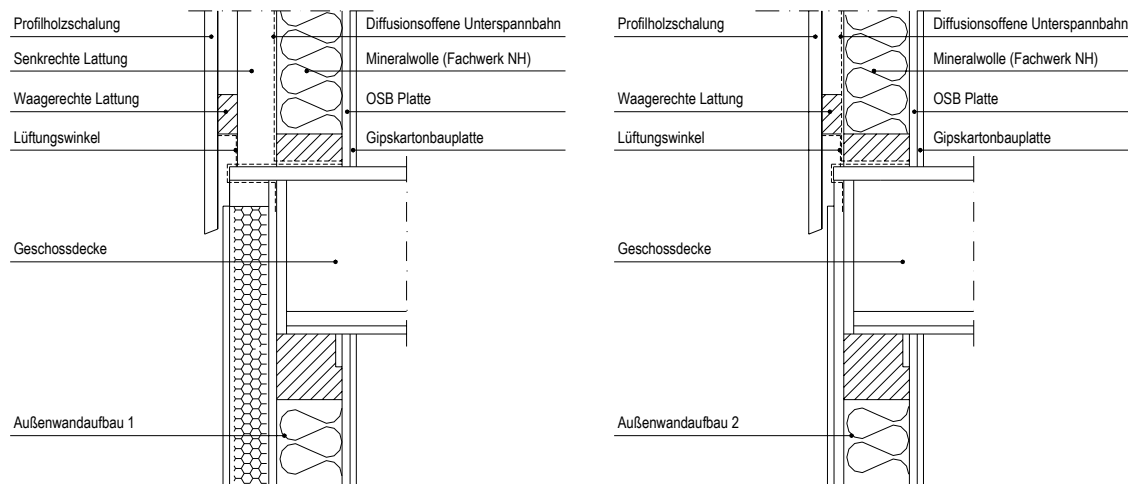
Außenwandaufbauten der Dachgeschosswände
